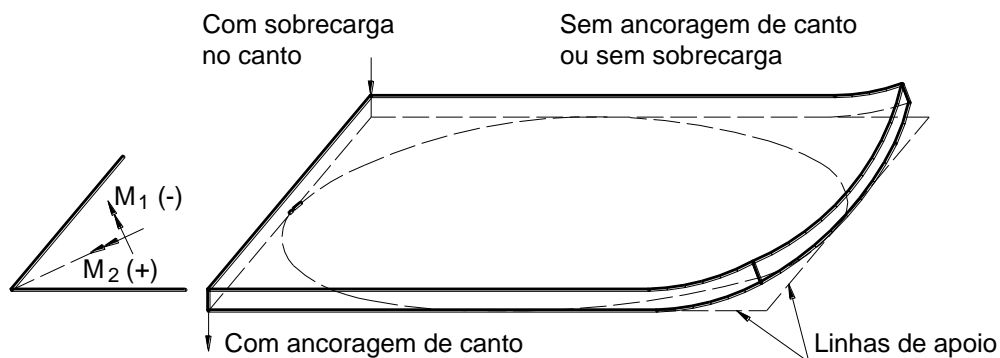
Laje retangular com apoios simples nos quatro lados.
